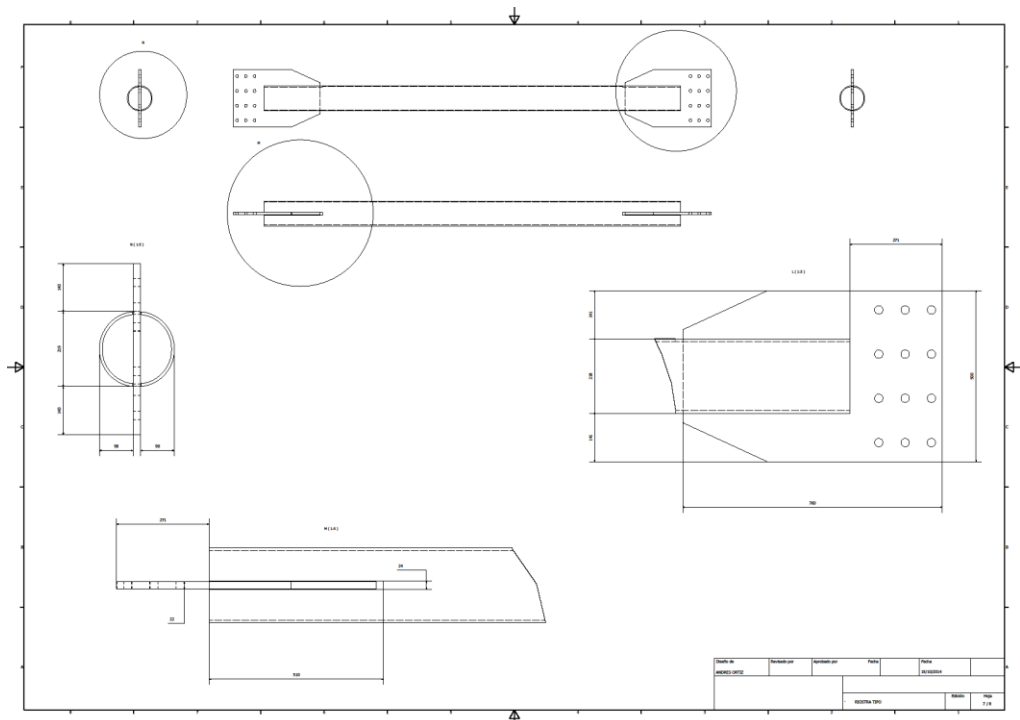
Planos de taller Riostra Tipo para Refuerzo Estructural Col. San Pedro.
